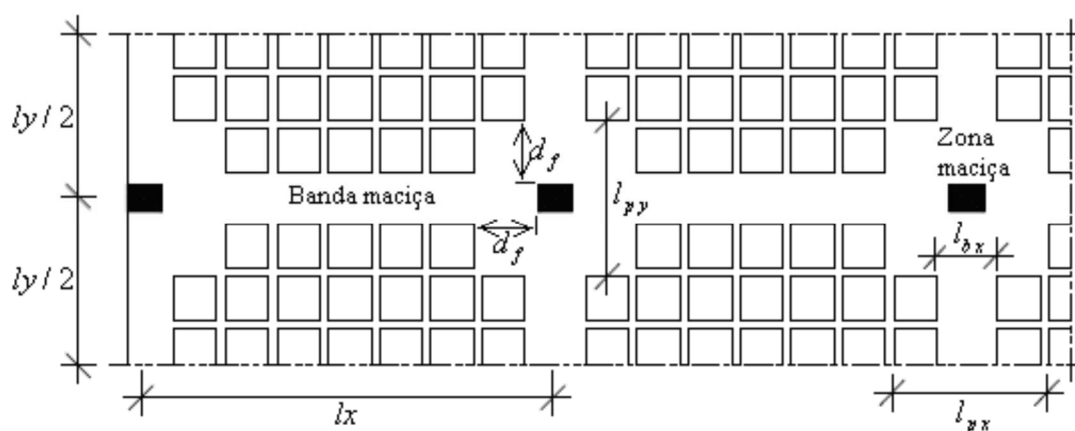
Elementos de dimensionais de uma laje fungiforme aligeirada [2]
